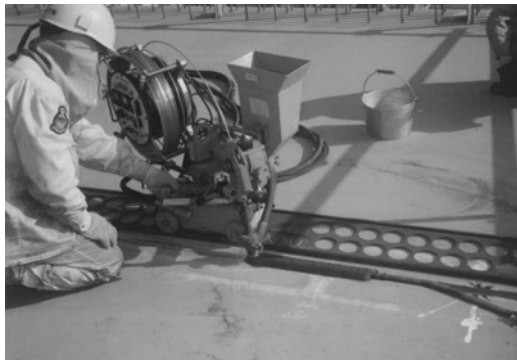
サブマージアーク溶接の施工状況
